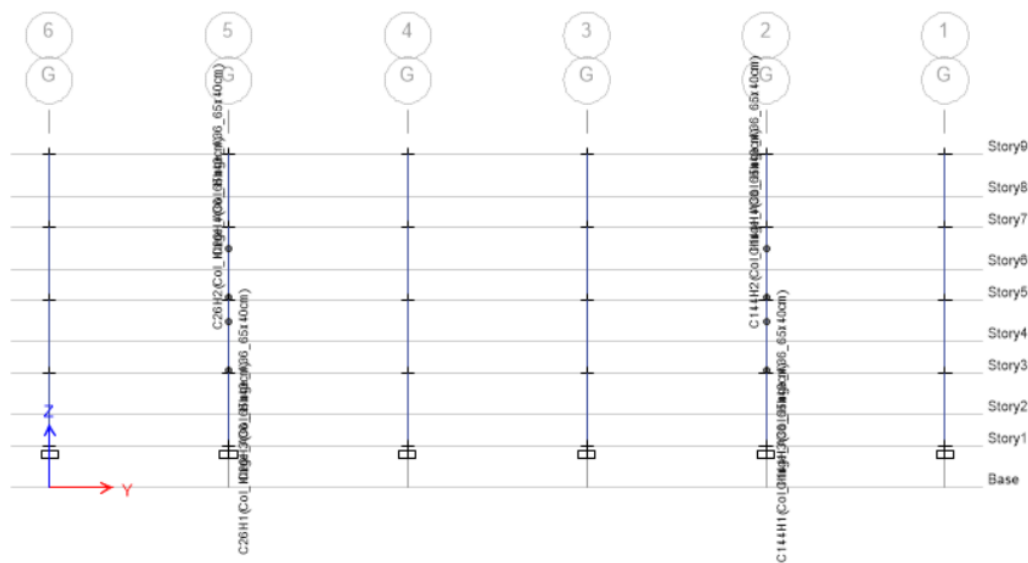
Columnas G2 y G5 encamisadas con acero A36 y con Hinges.
